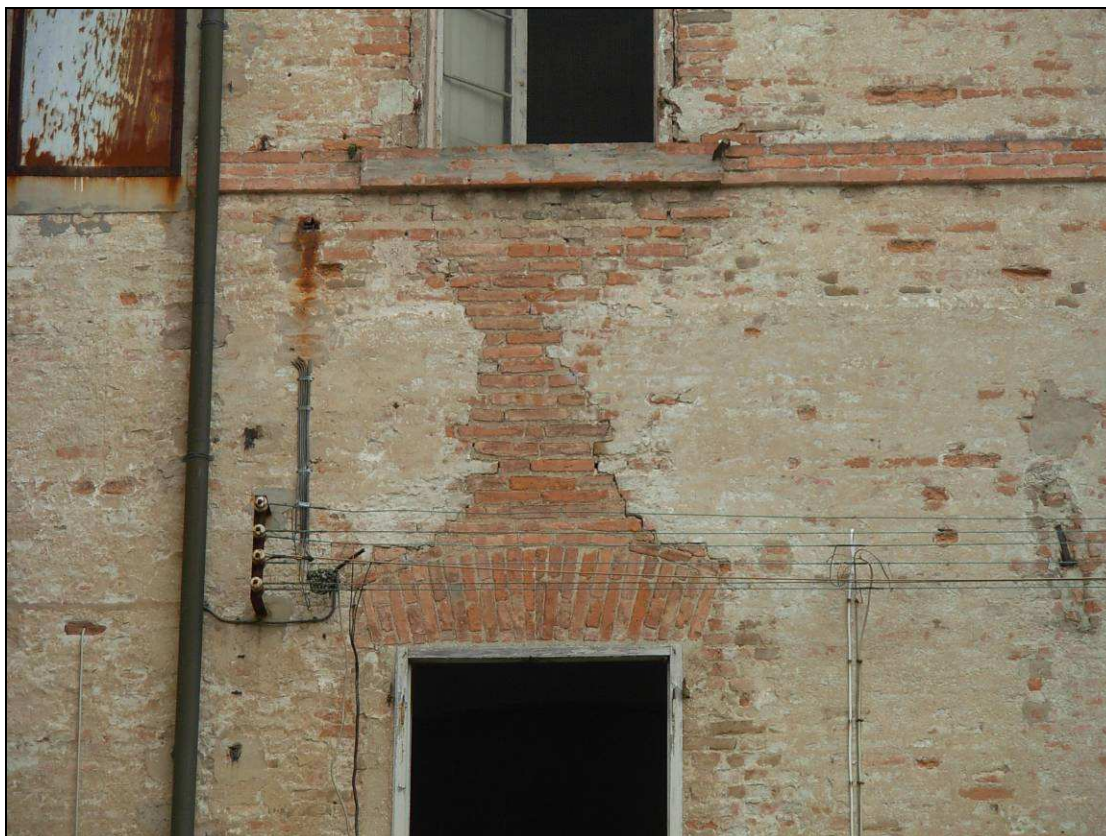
Ricostruzione fascia di piano (Foto n°1b - P.T.)
